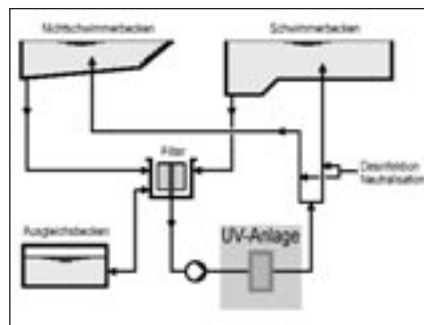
Einbau der UV-Anlage im Badewasserkreislauf des Hallenbads Langnau a.A.
